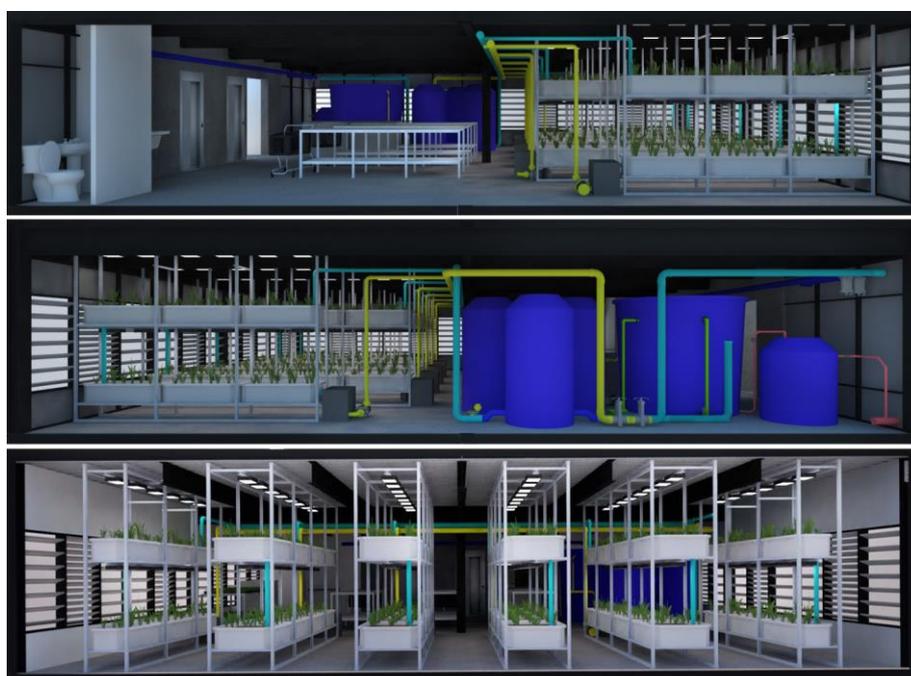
Modelo 1, interior do pavimento tipo, sistema de aquaponia
